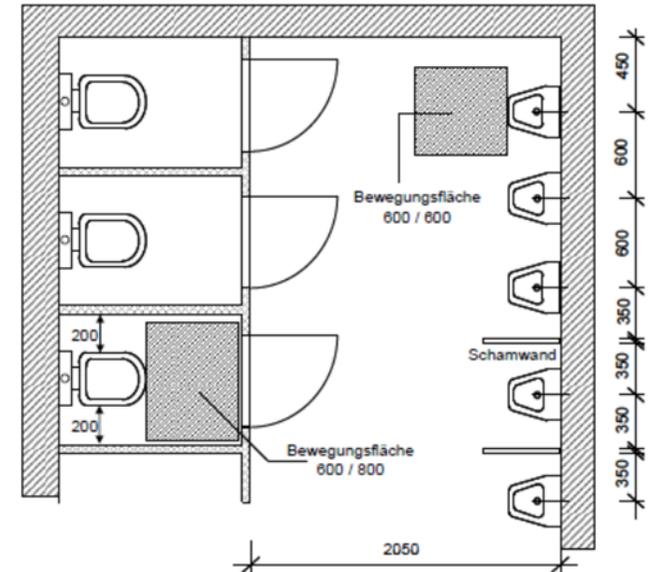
Einbündige Toilettenanlage mit Urinalen, Türanschlag nach außen (Maße in mm)
